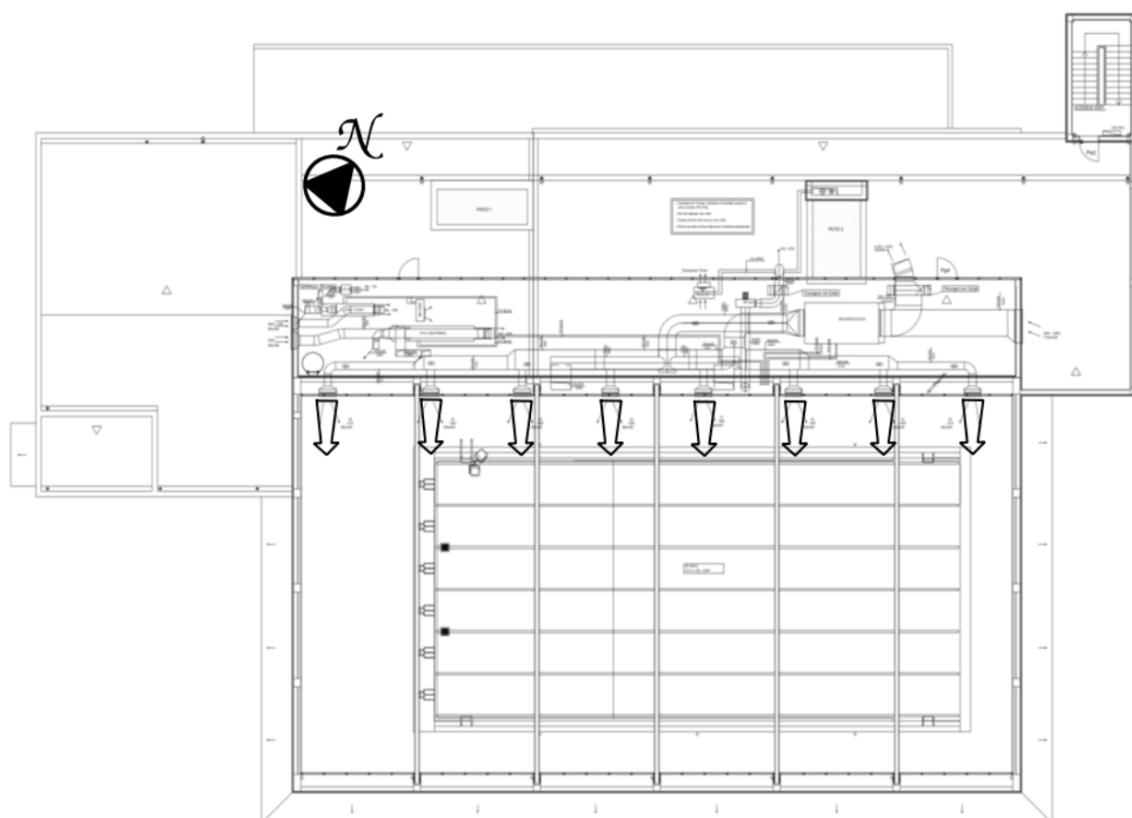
Planta à cota da cobertura da zona de serviços com identificação (a NO) da localização dos difusores de insuflação de ar na nave do tanque (cota 5,5 m. aproximadamente).
